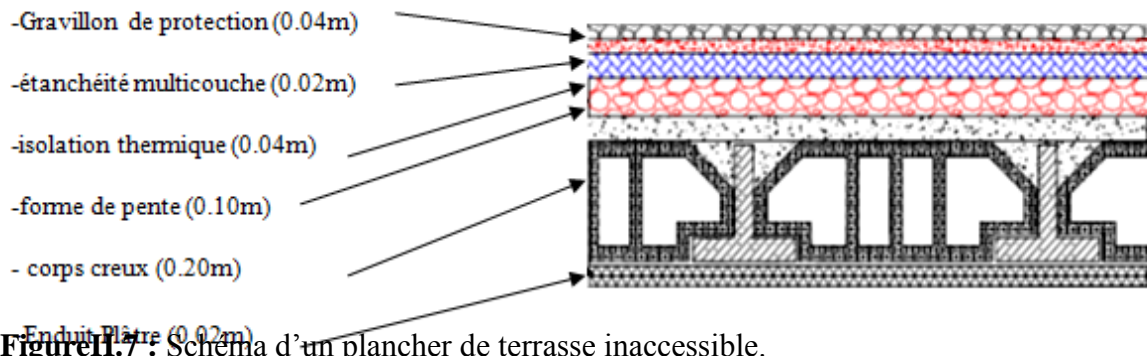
Schéma d'un plancher de terrasse inaccessible.
